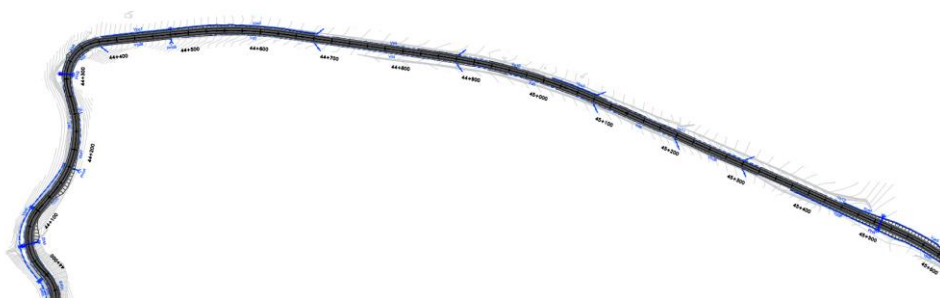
Excerto de traçado em planta do troço 1 (km's 43+975 a 45+600)
